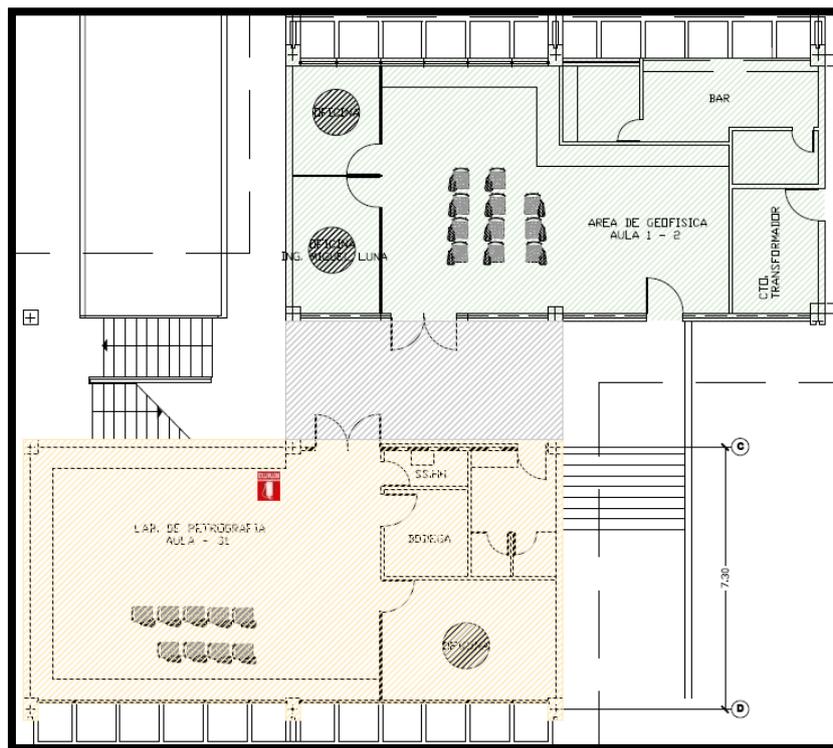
Extintores, planta baja, Edificio 20-A, Zona 1
